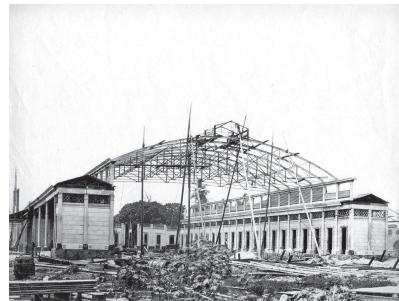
Montagem da estrutura de cobertura do saguão de passageiros da Estação da Calçada, antes do desabamento. Foto de Benjamin Mulock, dezembro de 1860. Fonte: Acervo do Institution of Civil Engineers London.
